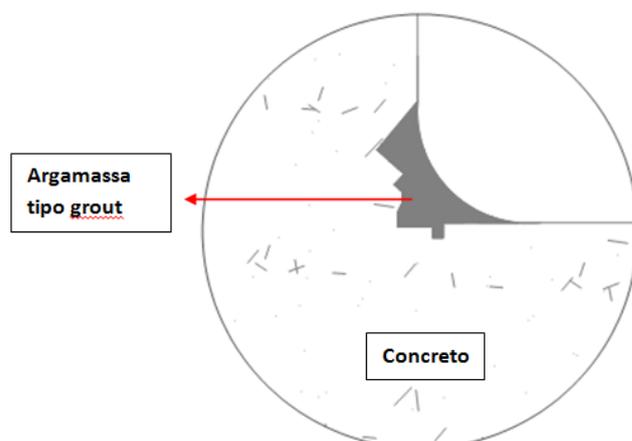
Detalhamento de meia cana executada em estrutura de concreto – Fonte: O autor
